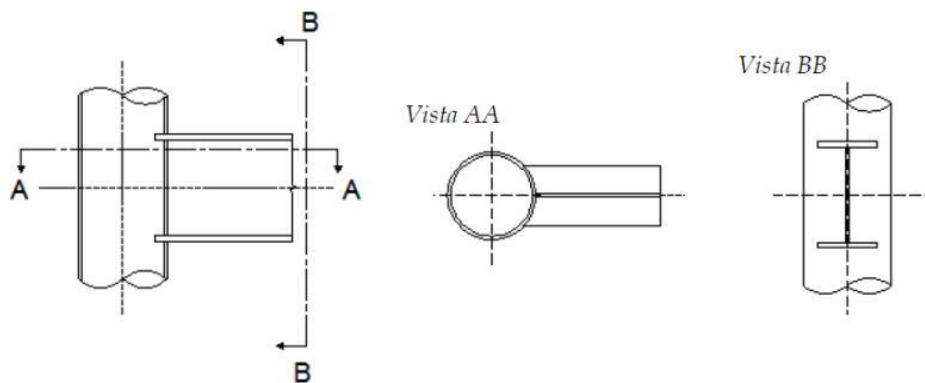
Ligação soldada entre coluna tubular circular e viga de perfil I.
